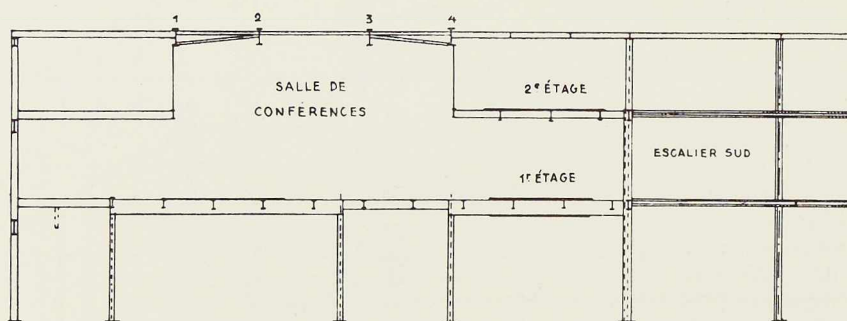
Coupe AA dans l'ossature du hall, montrant le système constructif employé.
